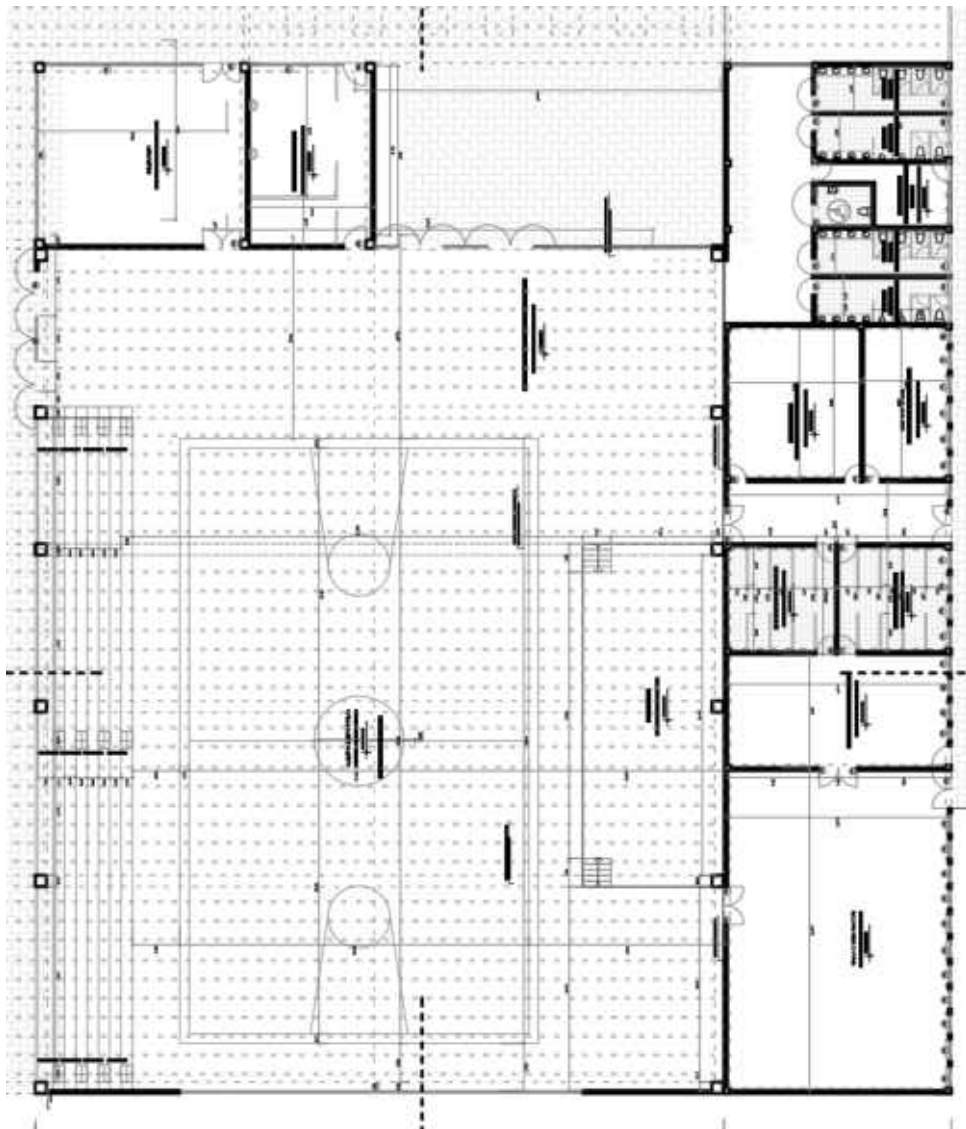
planta de bloque de polideportivo, fuente elaboración propia.
